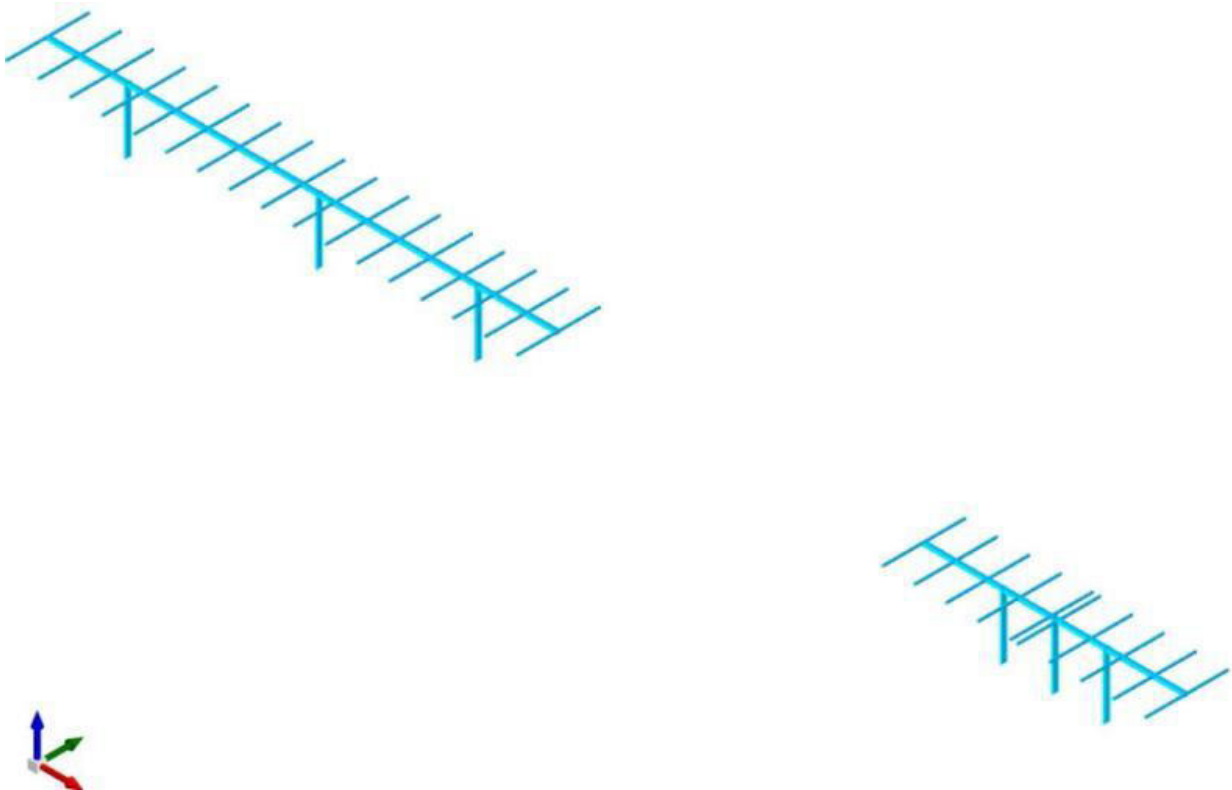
Vista assonometrica modello strutturale con posizione della "vela" orizzontale
